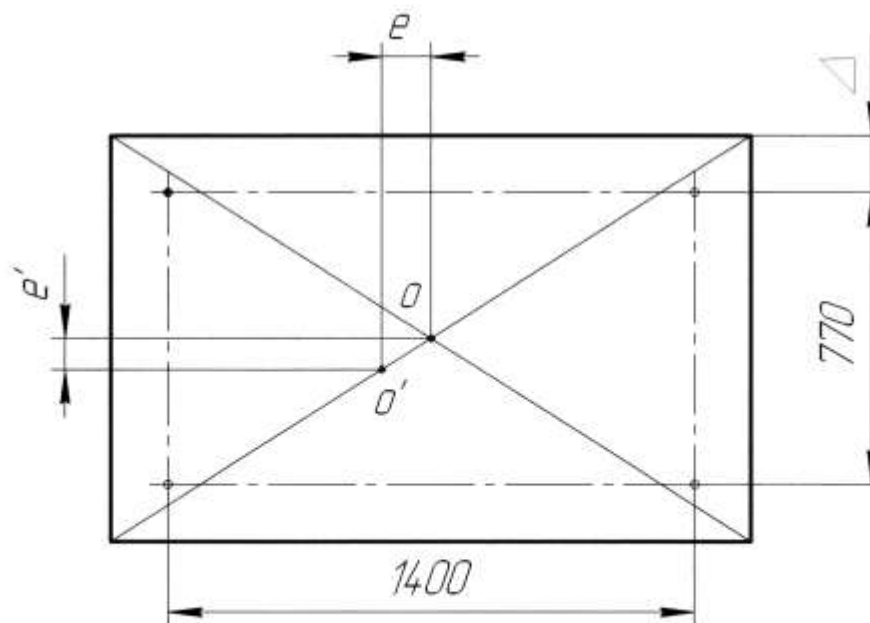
Схема фундаментной площадки под куттер Л5-ФКМ
